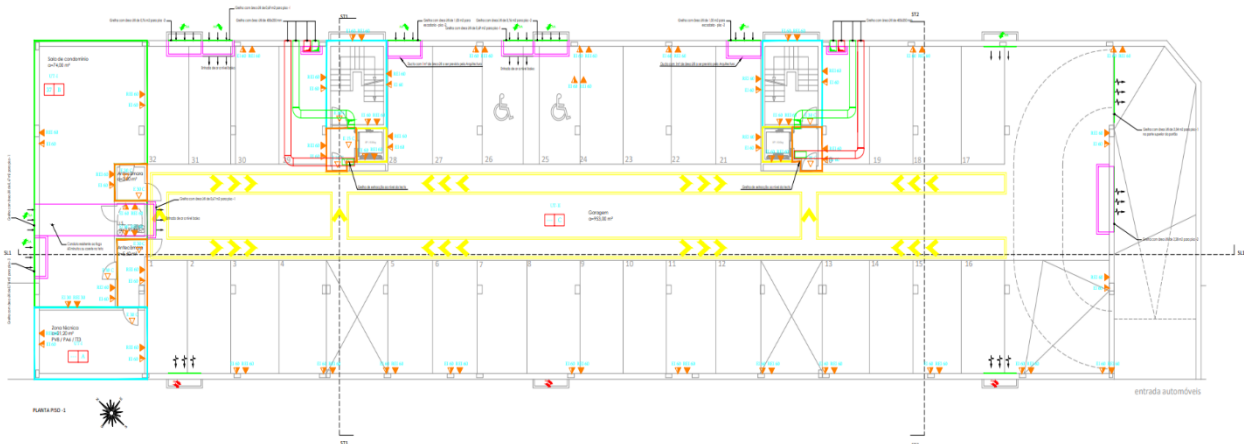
Projeto segurança - compartimentação e marcações no pavimento piso -1.
